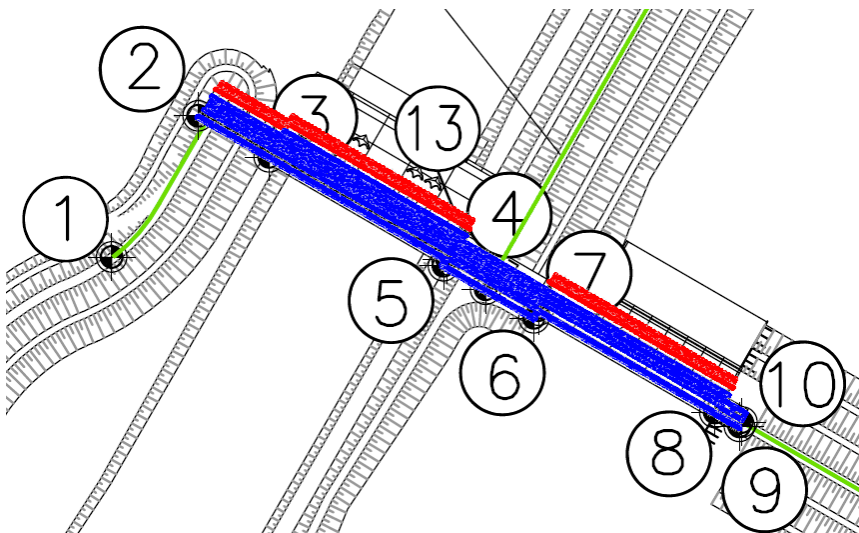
Interventi jet grouting Tipo A e Tipo B
